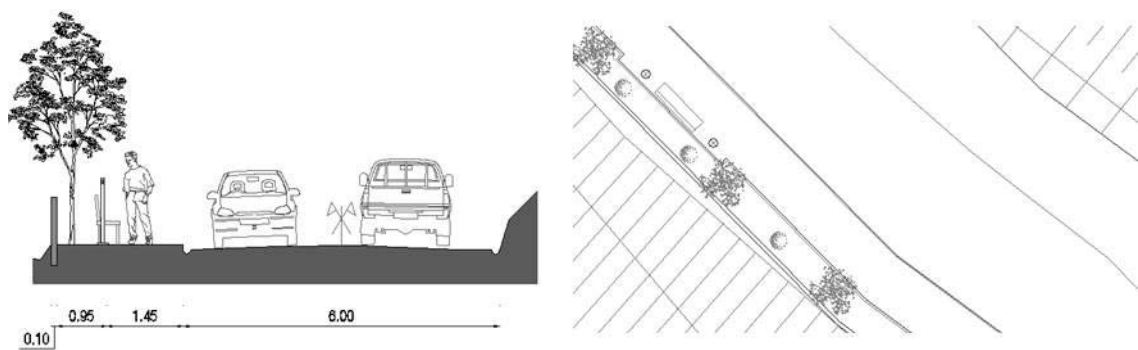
Composição de imagens: Perfil do arruamento (esq.) e pormenor da planta do arruamento (dir.)
